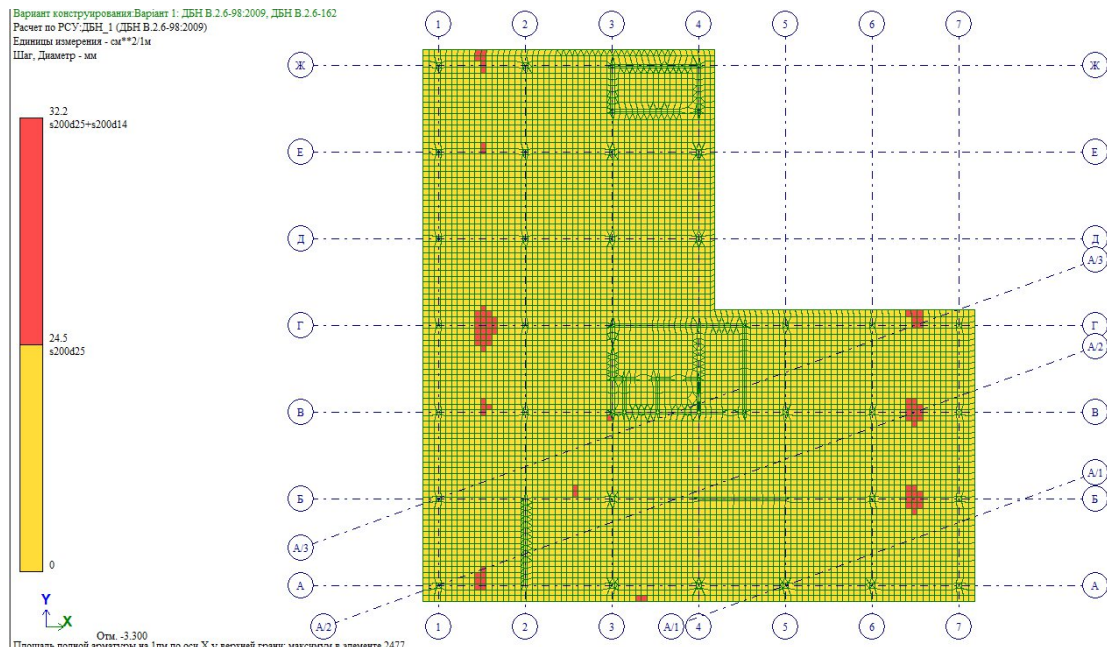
Розподіл площі верхнього армування фундаментної плити на 1 погонний метр уздовж осі X
